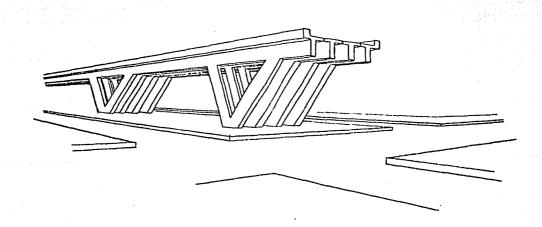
PUENTE DE CONCRETO PRESFORZADO
